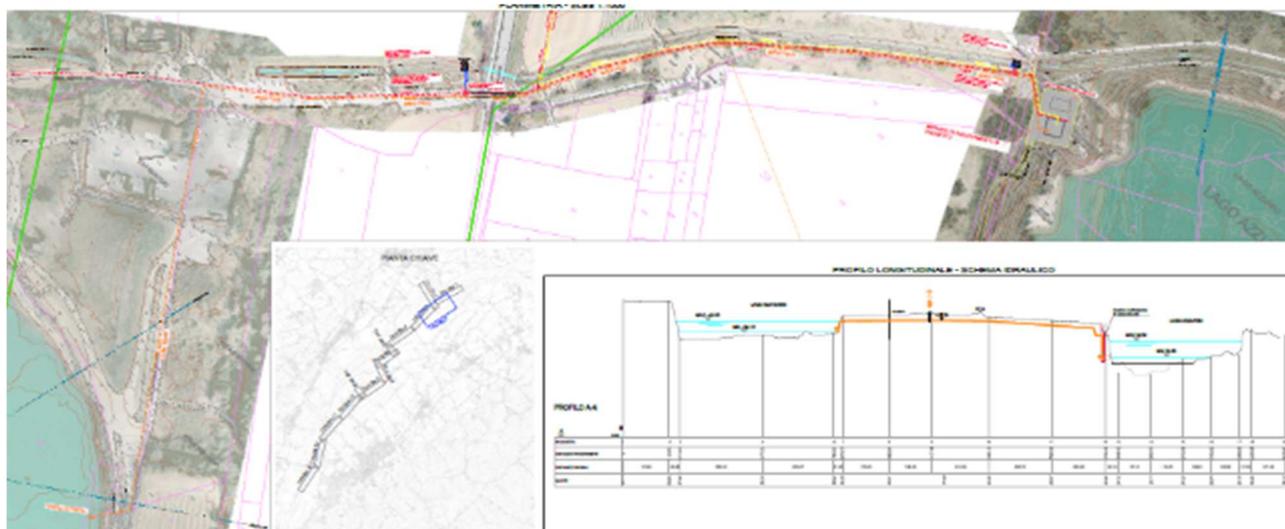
Planimetria e profilo della condotta di collegamento tra i laghi (tav. B.6.2)
